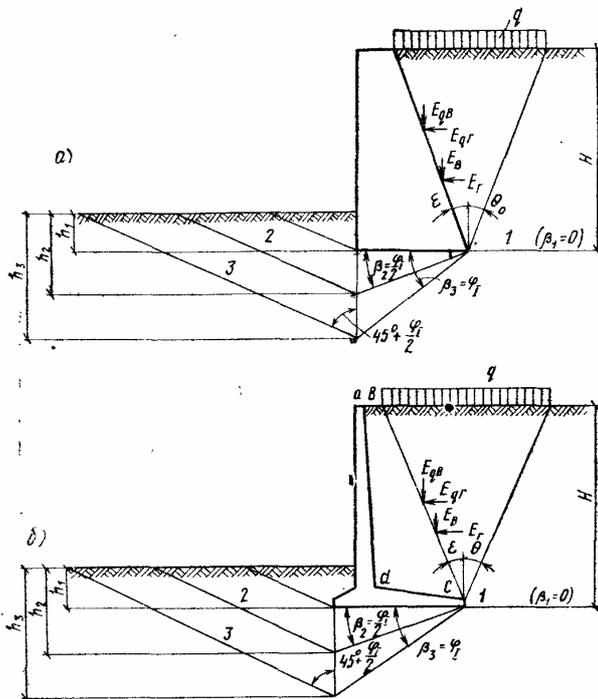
Схема к расчету устойчивости подпорных стен против сдвига при горизонтальной подошве
